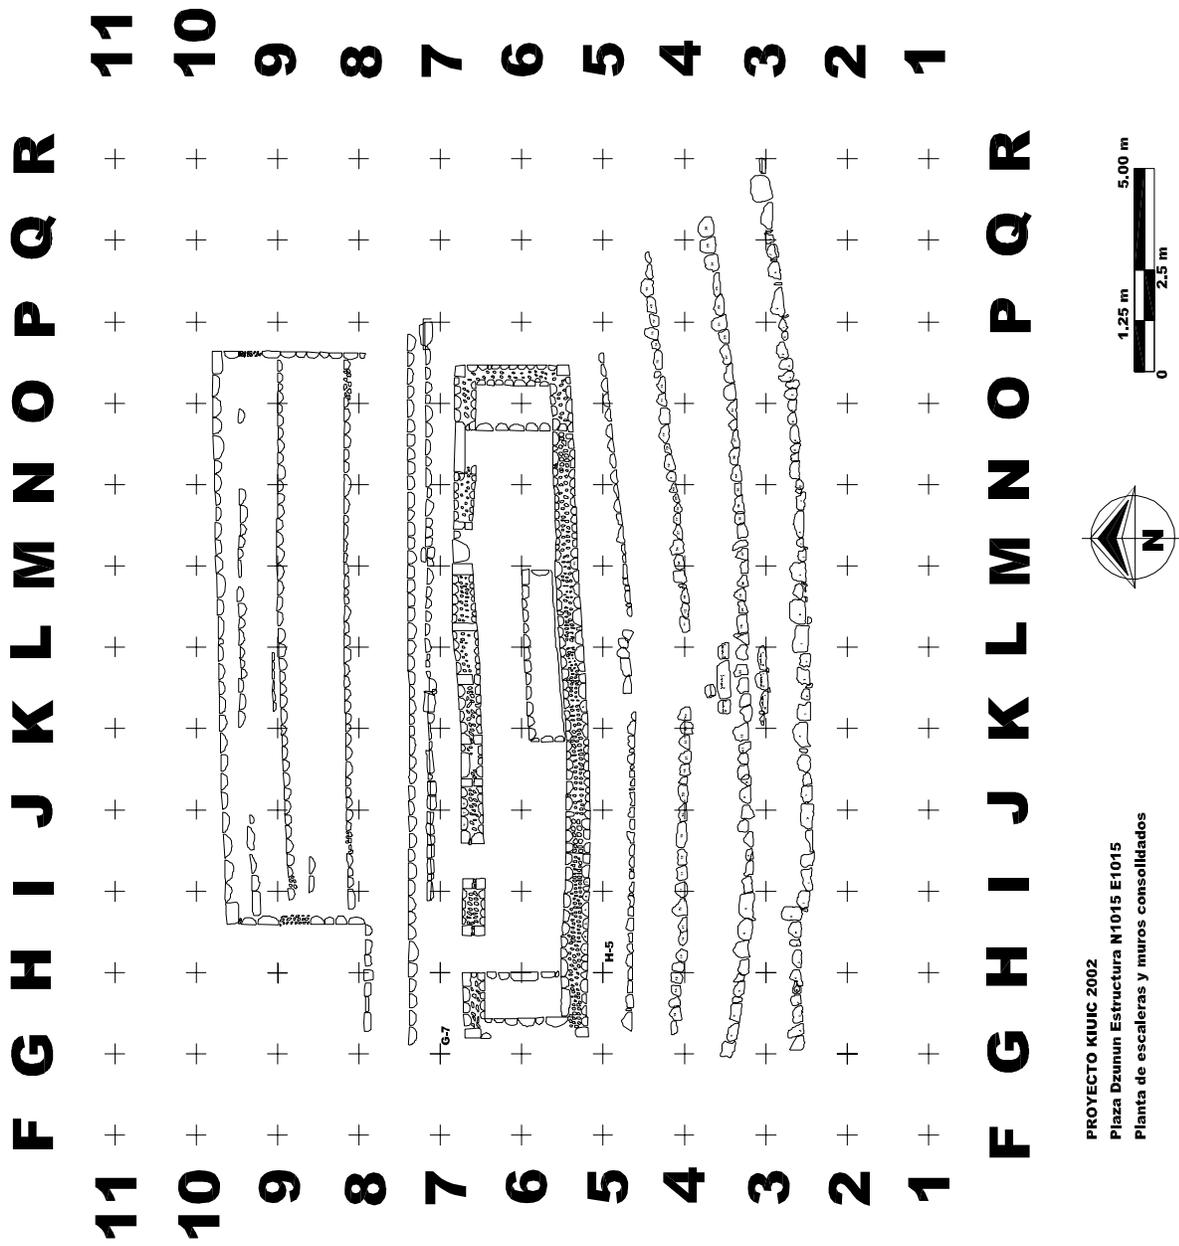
Planta arquitectónica de la Estructura N1015E1015, incluyendo las subestructuras halladas.
